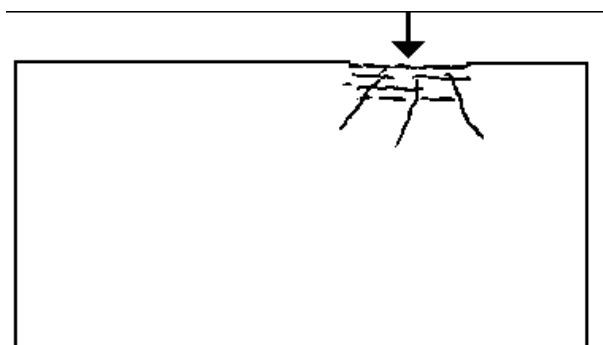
Típica fissura de ruptura pontual da alvenaria sob o ponto da aplicação da carga e propagação de fissuras a partir deste ponto (Argilés, 1999)
